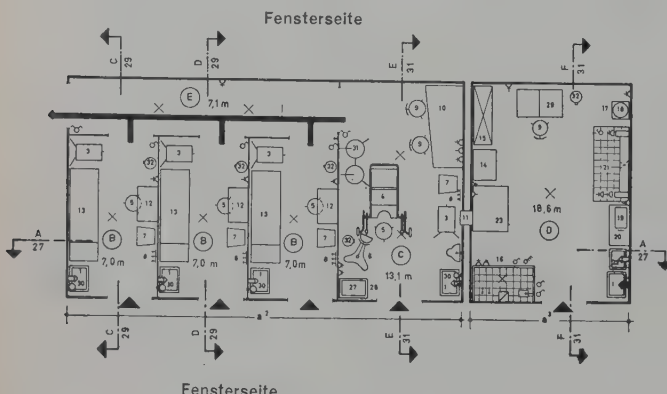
Raumgruppe Dermatologie Grundriß 1:150
